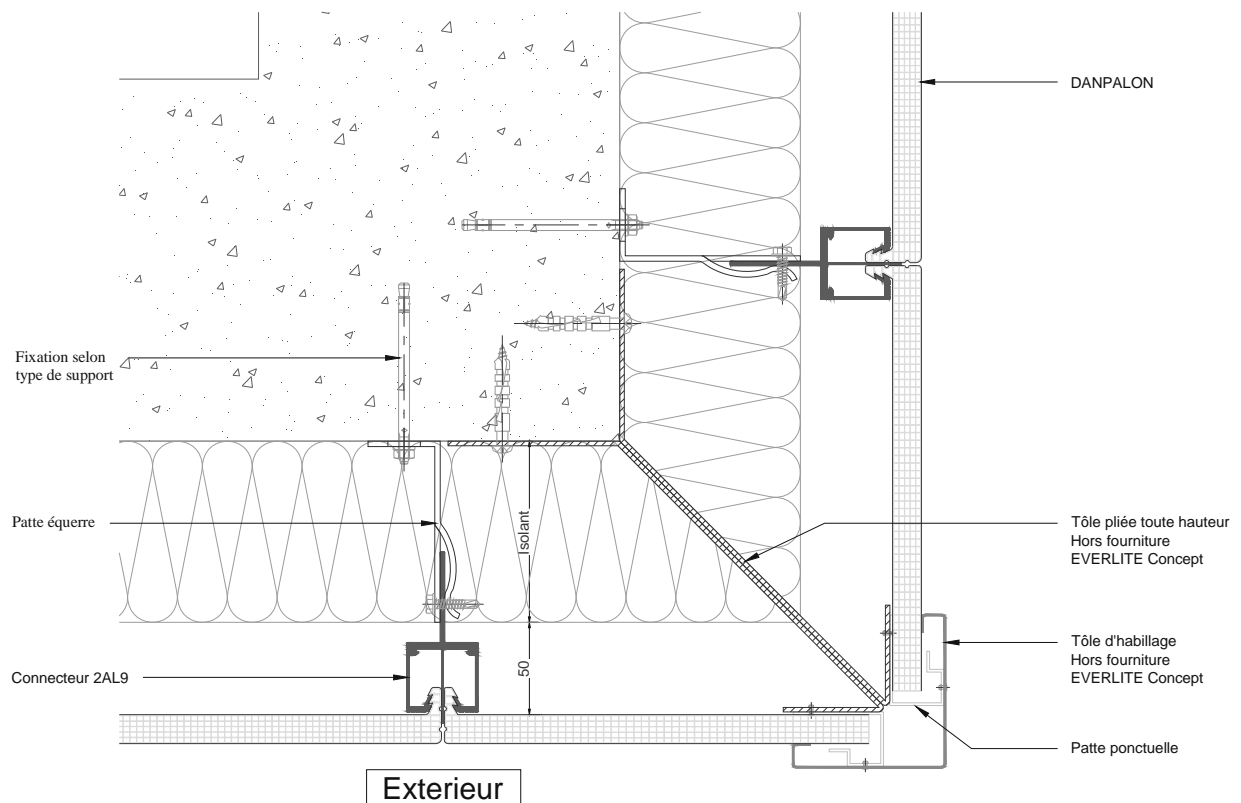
Encadrement de baie - Coupe horizontale (tableau)
